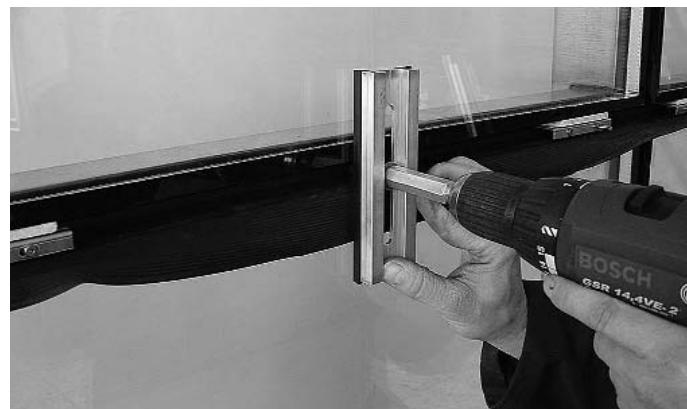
Füllelement mit Anpressprofil-Stück sichern
